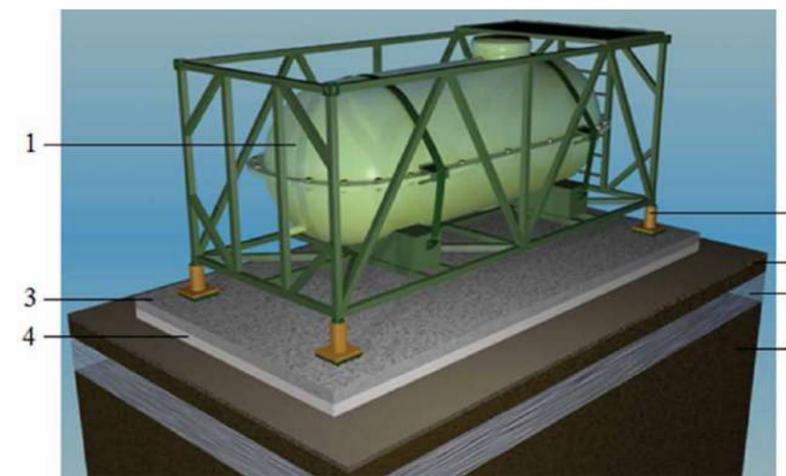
Установка контейнер-цистерны на бетонной площадке с применением теплоизоляционных материалов: 1 – резервуар; 2 – теплоизолированные опорные лапы; 3 – бетонная площадка; 4 – теплоизоляционная подушка; 5, 7 – слой почвы; 6 – вечномёрзлый грунт
